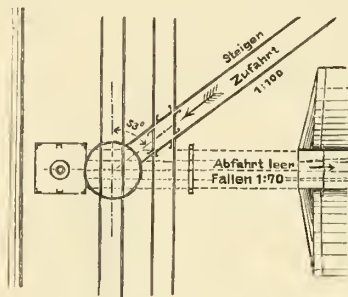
Grundriss. Maßstab 1:600.
